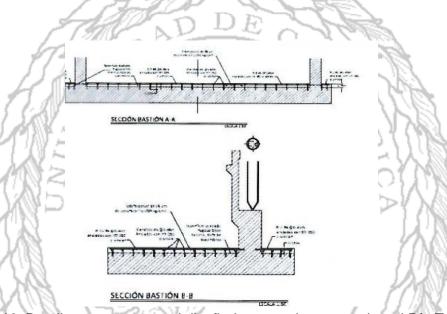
Detalle propuesto por el diseñador para el puente sobre el Río Tenorio.
